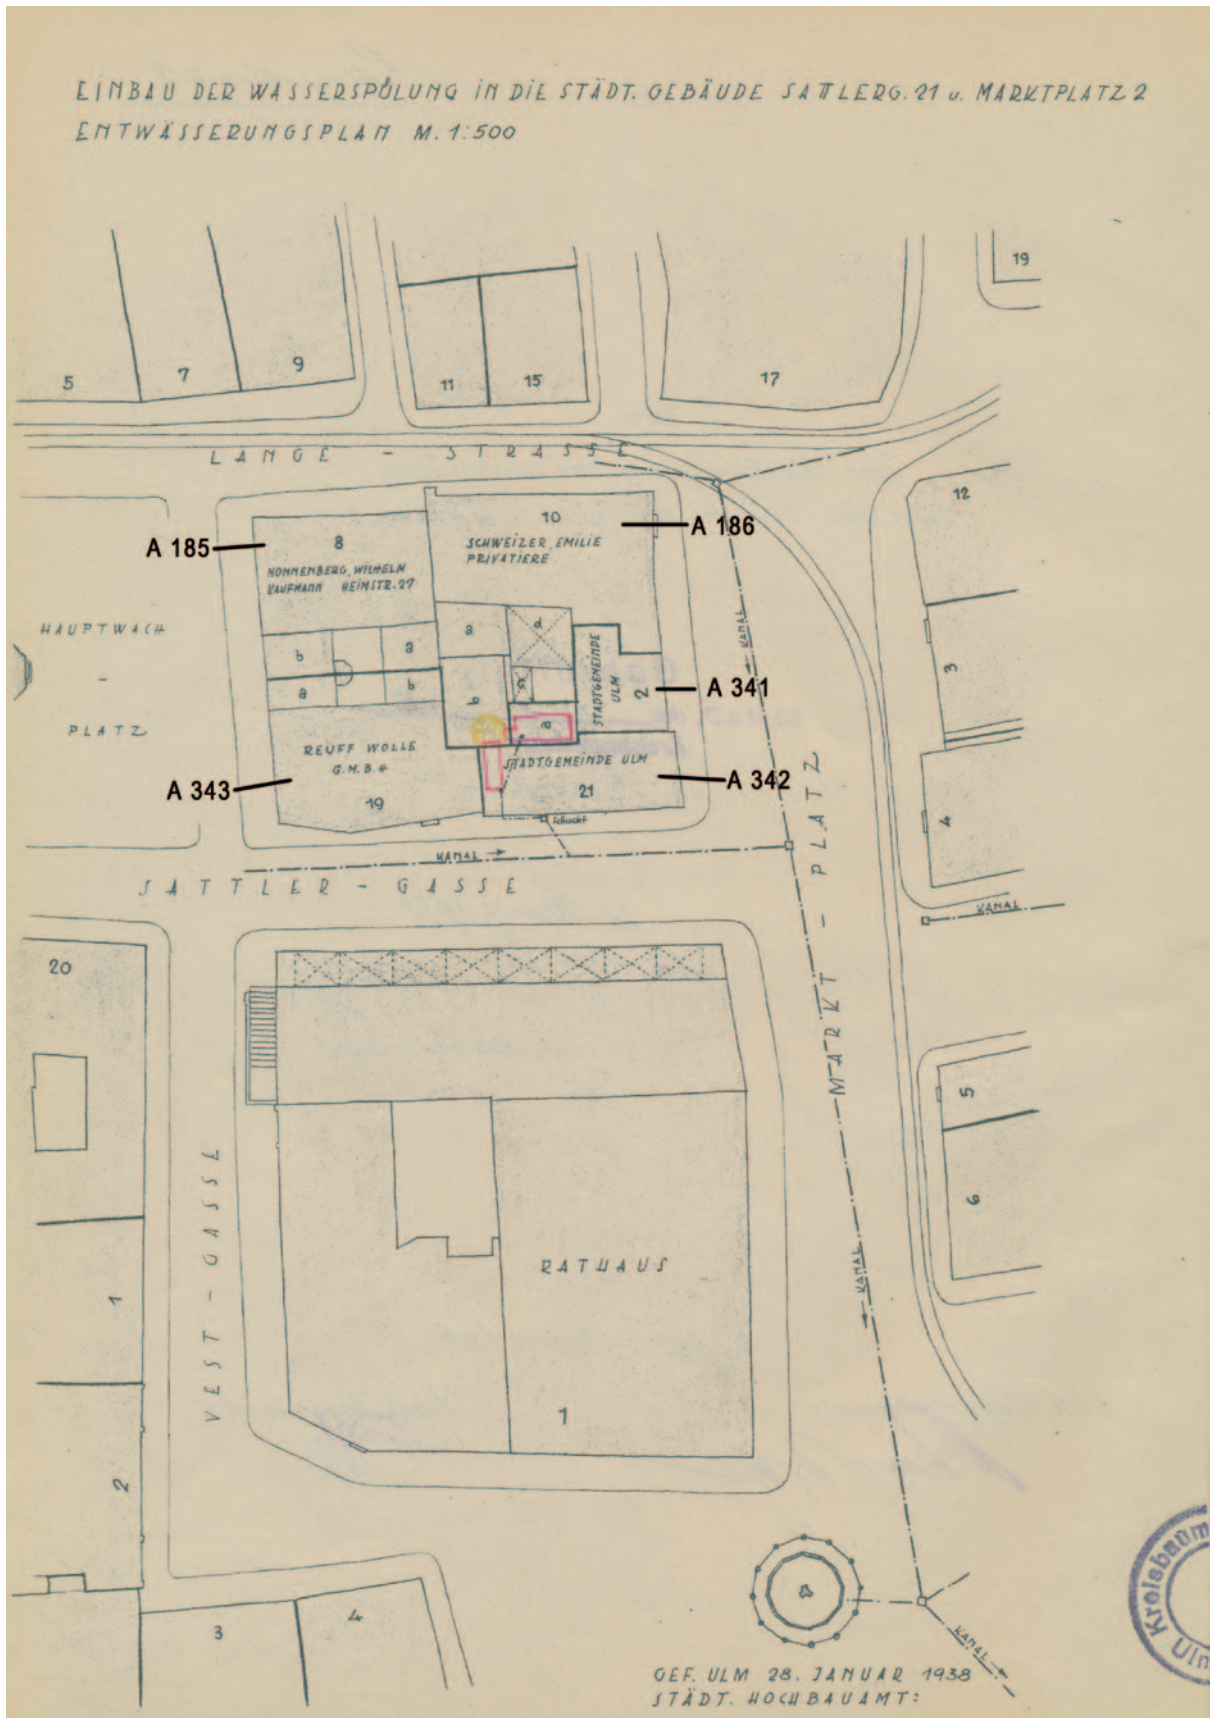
Gebäude Lange Straße 8 (A 185), Lageplan mit Kennzeichnung der Haupt- und Nebengebäude, Baumaßnahme 1938 zur Einrichtung der Wasserspülung in Marktplatz 2 (A 341) und Sattlergasse 21.
